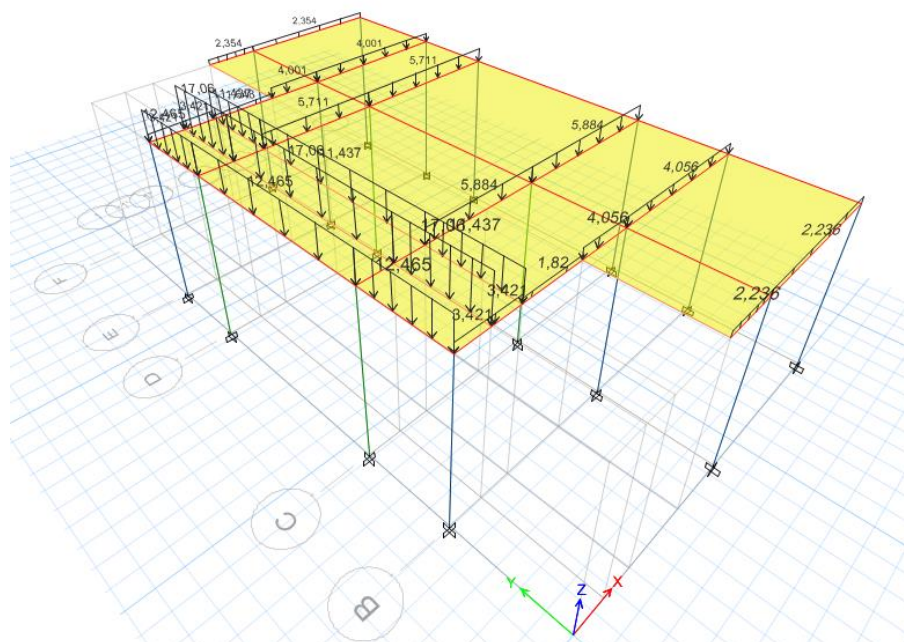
Cargas muertas sobre estructura. Carga sobreimpuesta (KN/m)
